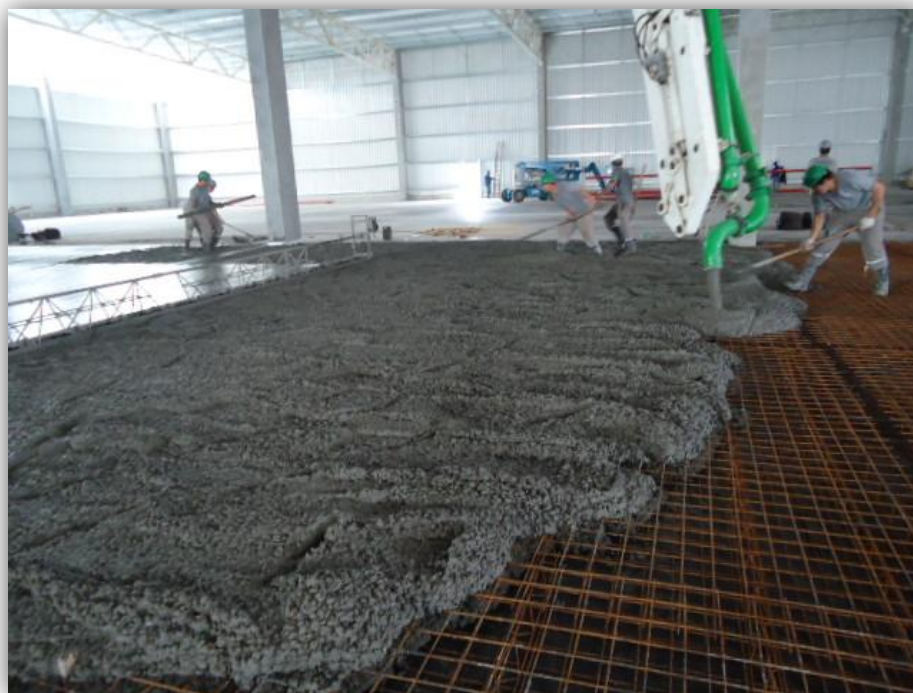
Lançamento de concreto próximo ao piso (Fonte: Própria)
